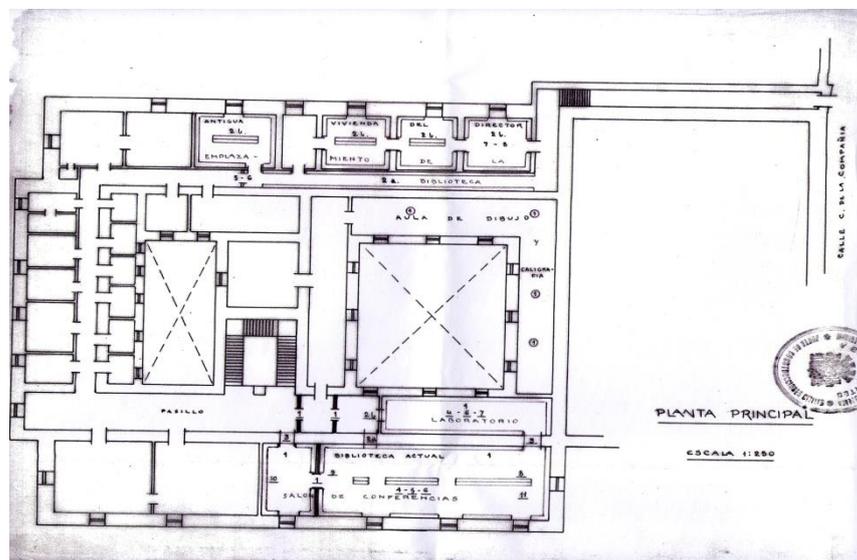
y 16 Planos: Planta principal y baja, 1932. Escala 1:250.
